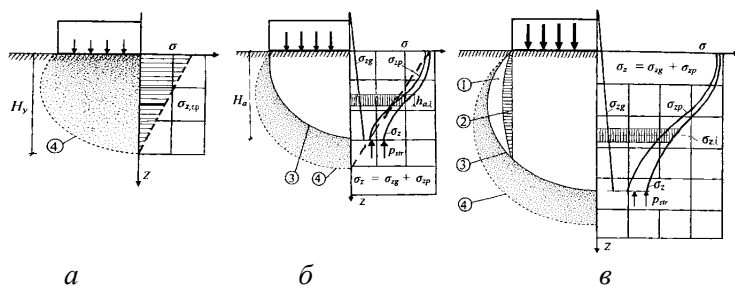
Схемы развития деформаций в основании фундаментов: 1 – зона остаточных деформаций от поперечного расширения грунта; 2 – эпюра зоны поперечных деформаций; 3 – граница зоны уплотнения от вертикальных напряжений; 4 – граница зоны упругих деформаций
